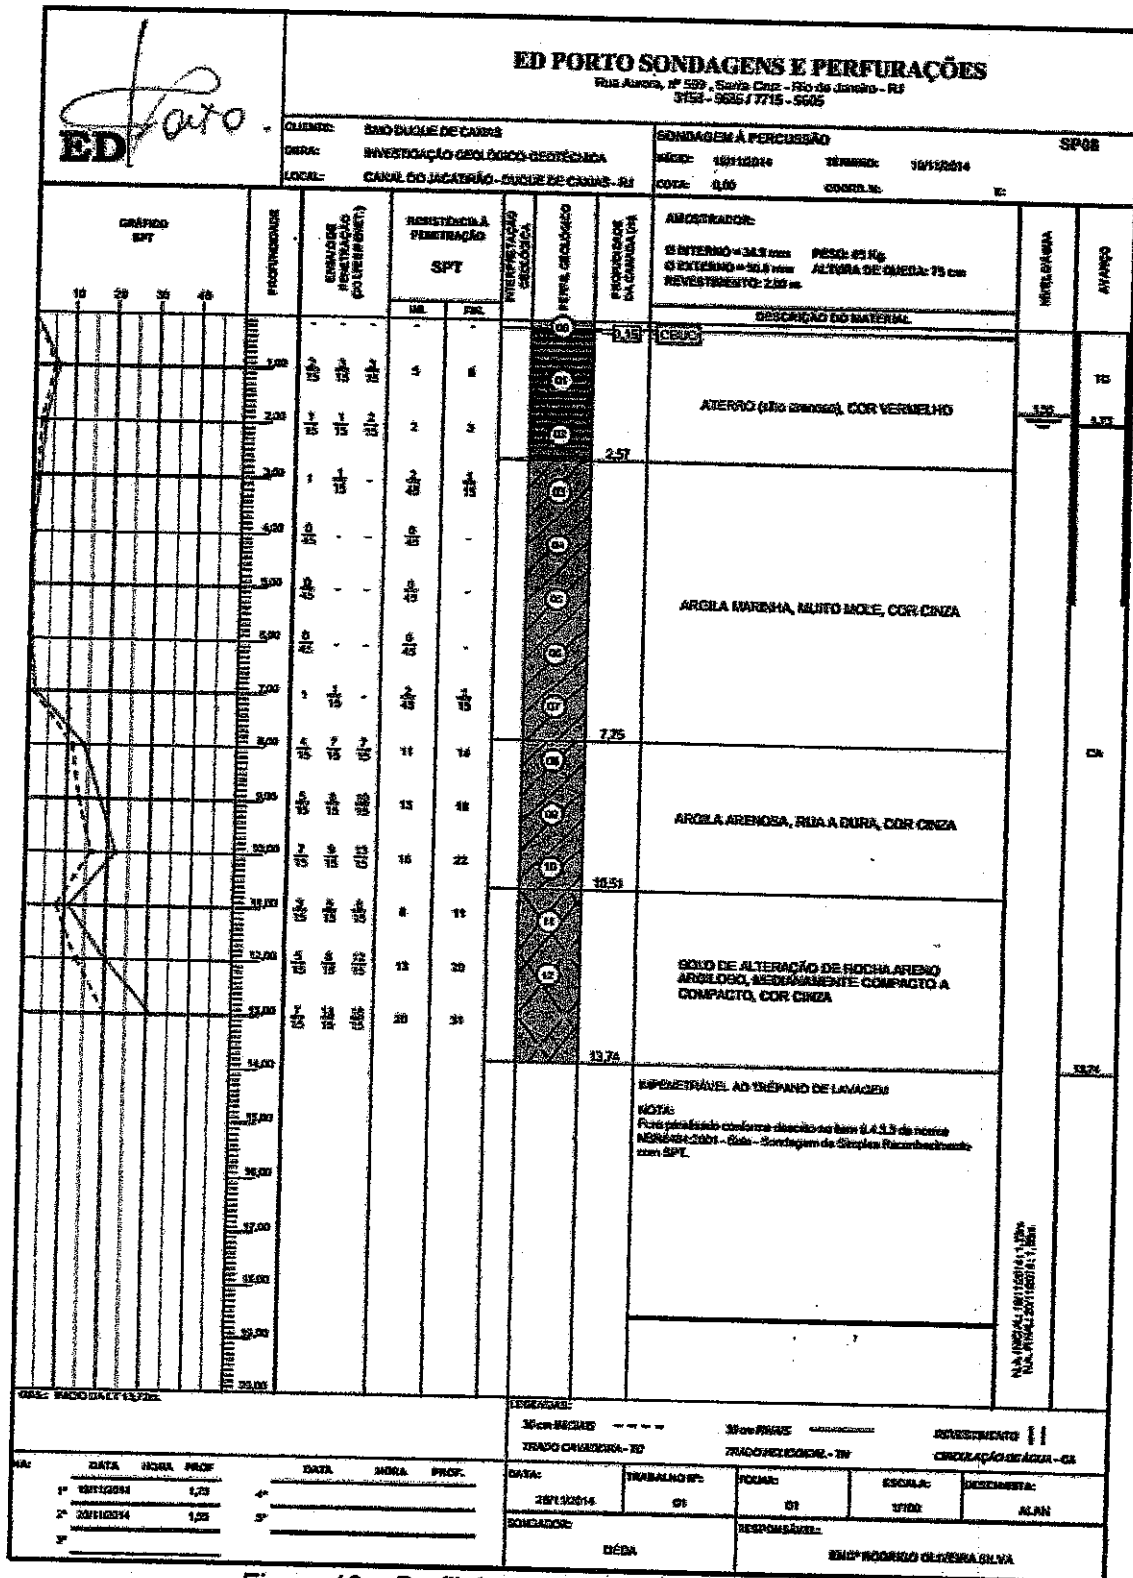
Perfil de sondagem SP-08 (Parte 1/1)
